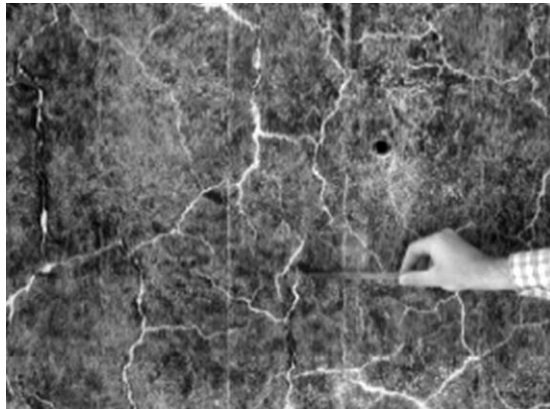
Fisuras en mapa causadas por la RAS en una pared.
